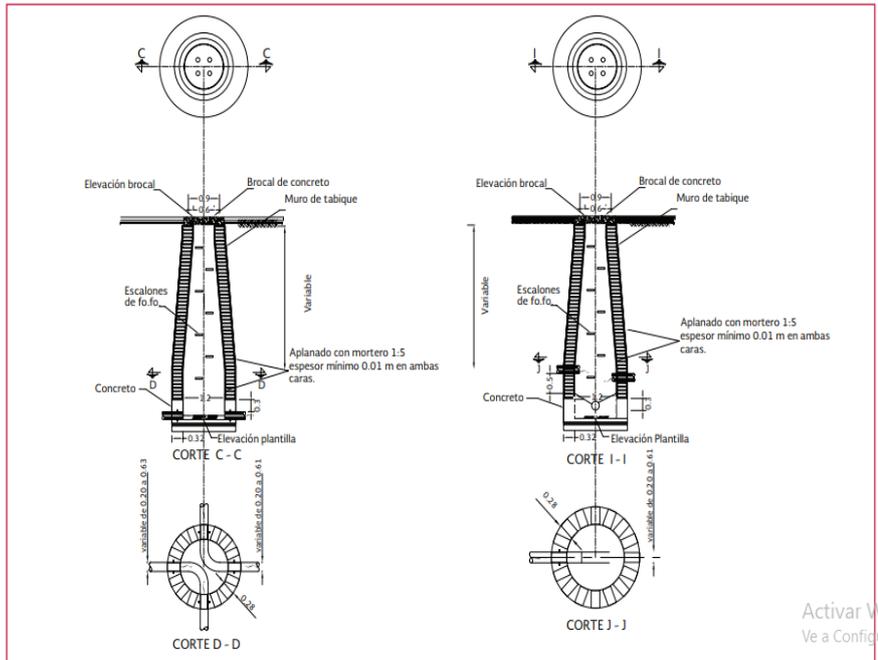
Pozo de visita red de alcantarillado sanitario.
